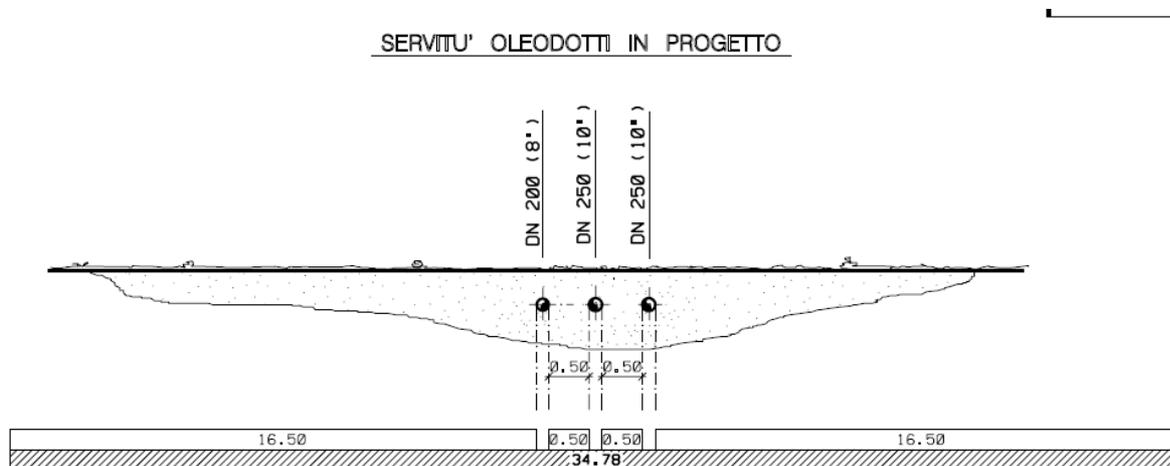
Individuazione della larghezza delle aree sottoposte a servitù non edificandi (Fonte: stralcio della planimetria catastale con fascia di asservimento – eni, emissione finale 27/06/2013)
